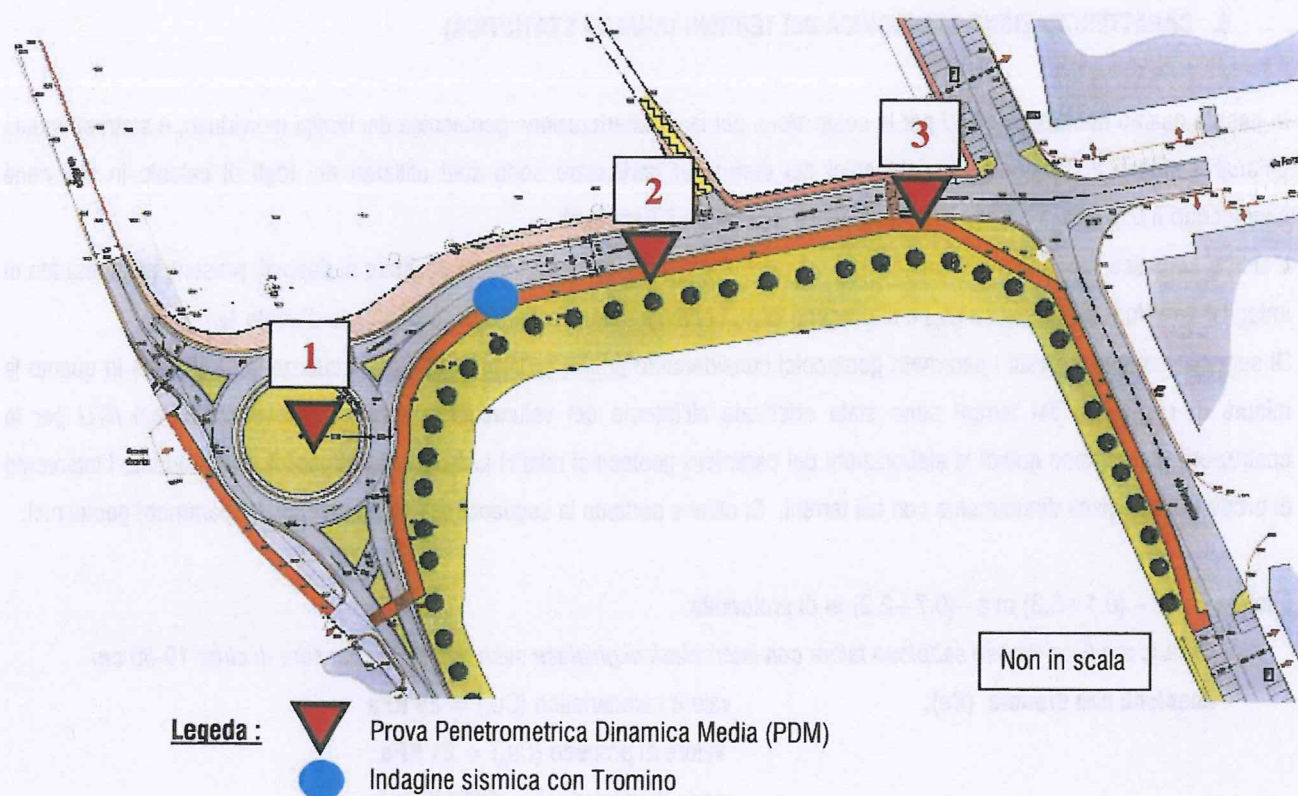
Planimetria non in scala con ubicazione prove eseguite
